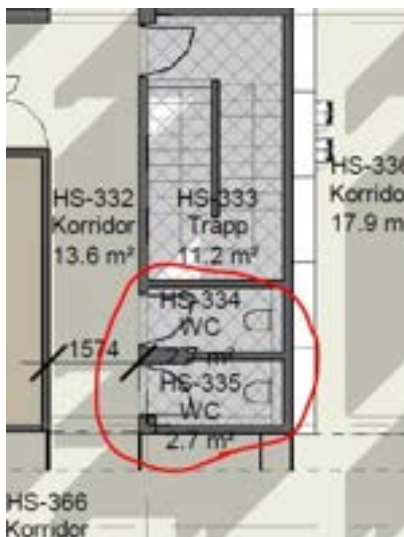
Plan 1. WC med spanskvegger
